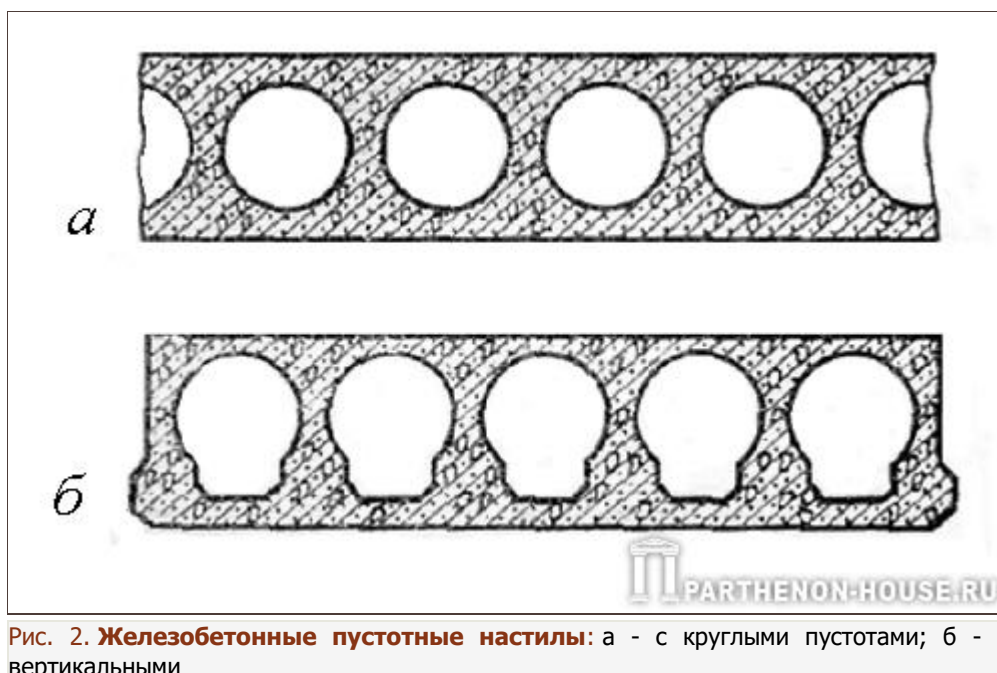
Железобетонные пустотные настилы: а - с круглыми пустотами; б - с вертикальными
